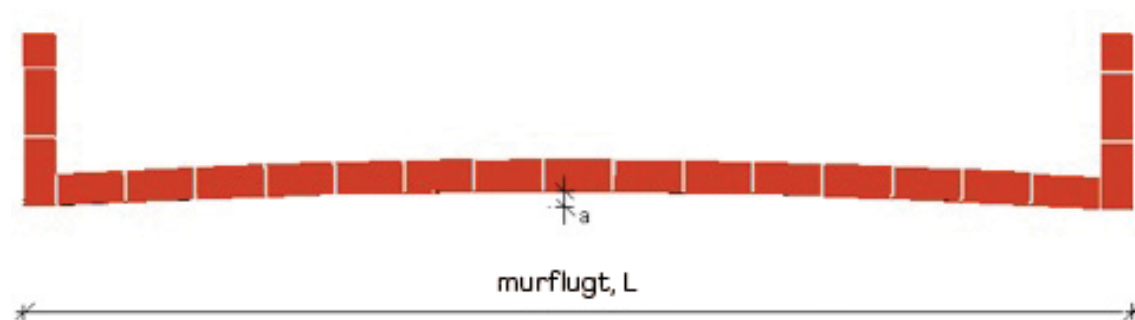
Murflugt, vandret plan – lokal bue/lunke, afhængig af facadens flugt.
